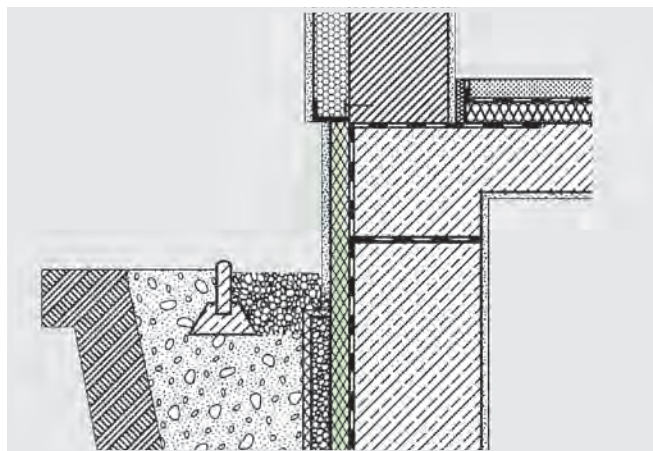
Pripojenie k pivničnému svetlíku bez vzniku tepelných mostov
